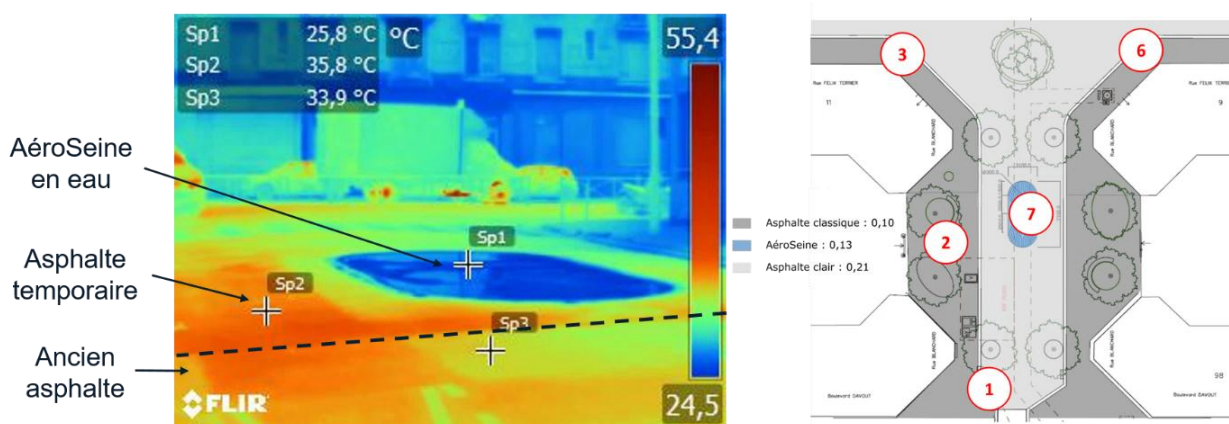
Photographie infrarouge du dispositif en eau (gauche) et plan avec albédos correspondants (droite)
